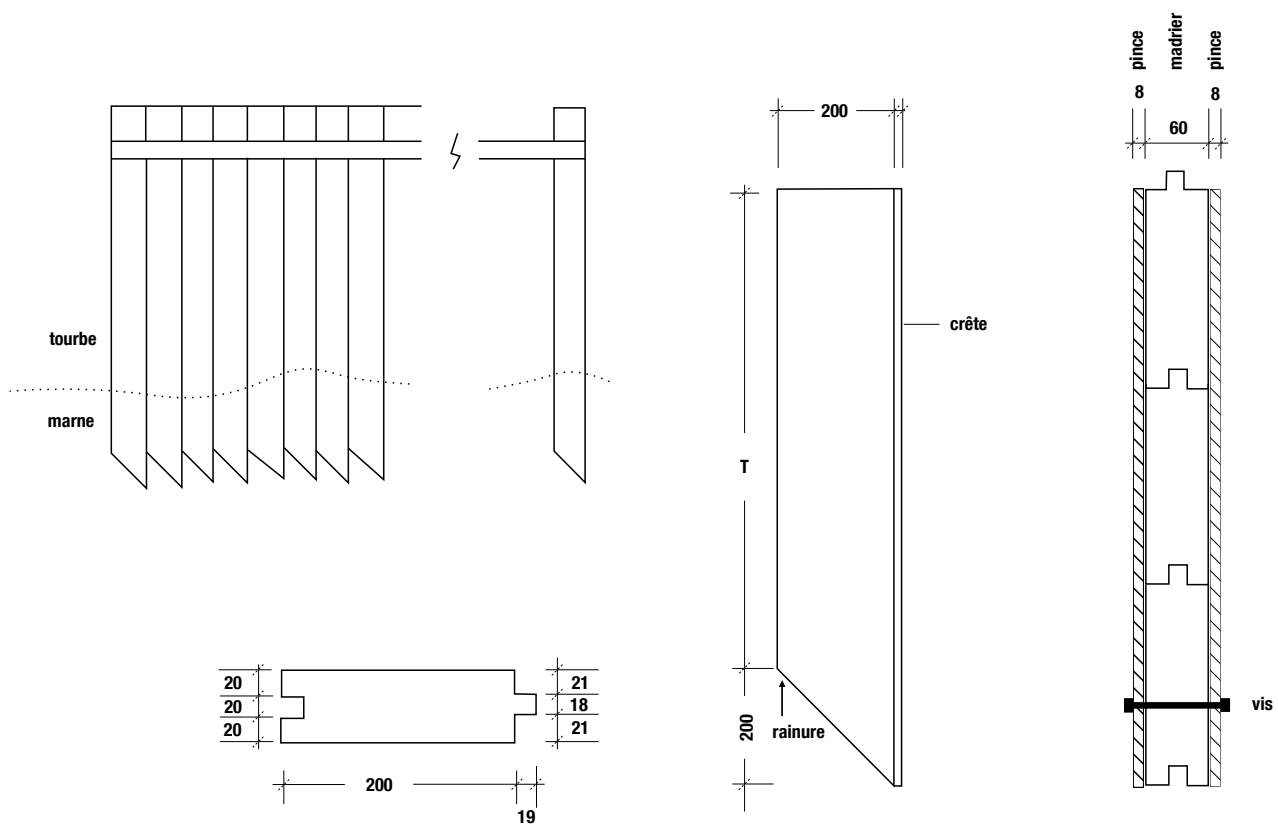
Plan de construction pour une palissade de bois; selon la hauteur et la largeur, d'autres dimensions sont possibles; types de bois: sapin, mélèze, chêne, pin; bois frais, sciage brut; dimensions en mm
